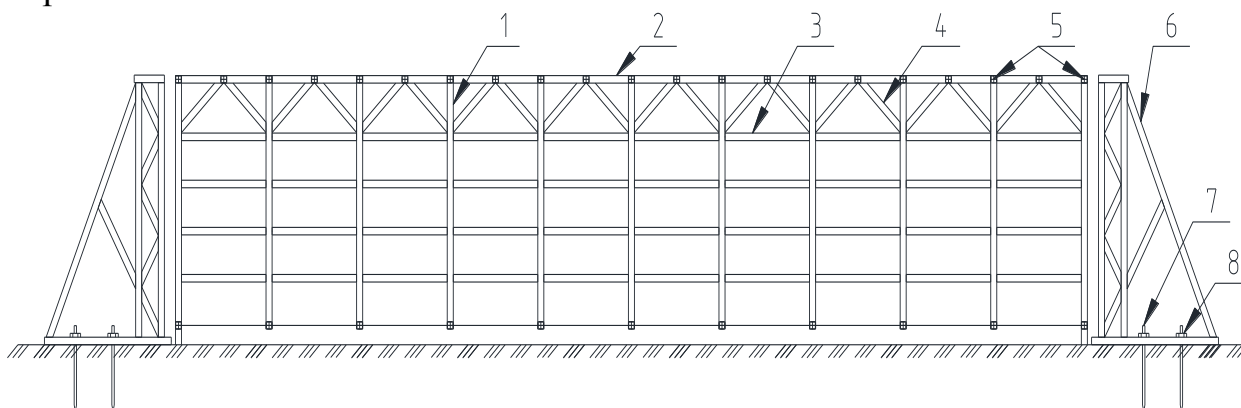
Продольный разрез базового блок - модуля с элементами усиления:
